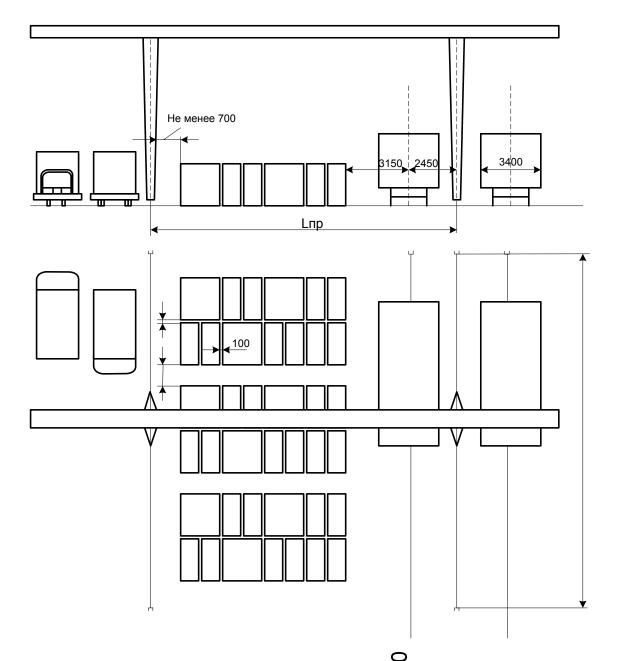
Поперечный разрез и план контемерной площадки для среднетоннажных контейнеров с двумя грузовыми фронтами
